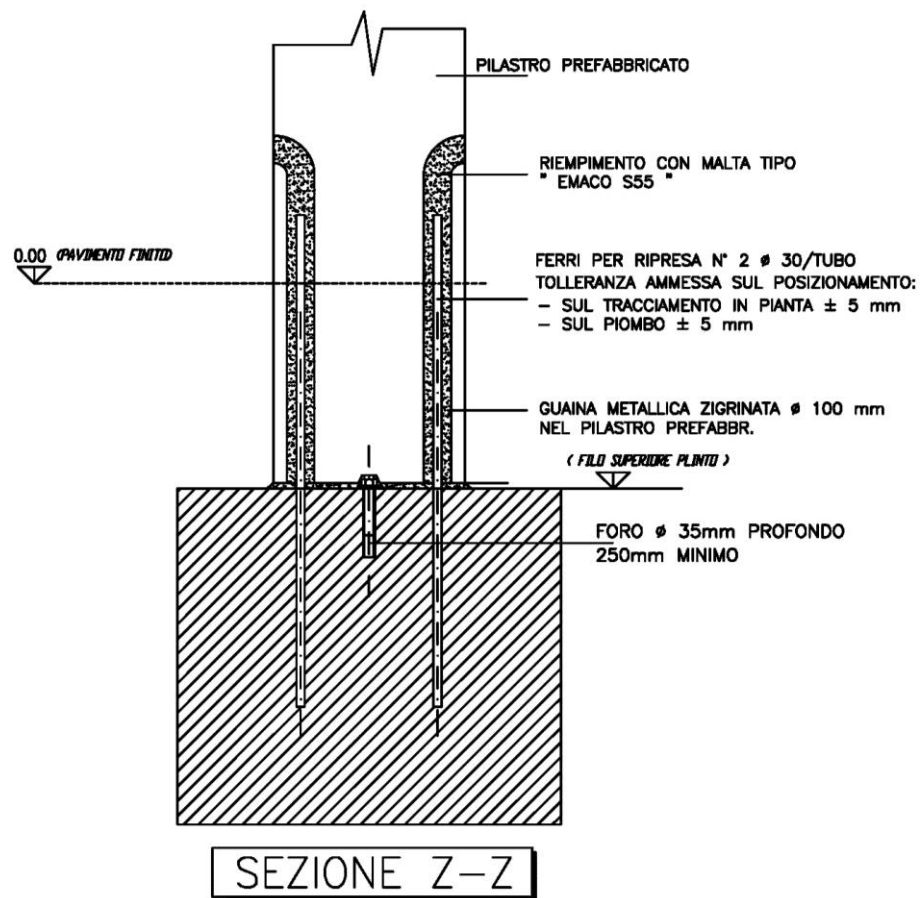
Sezione e particolare costruttivo pilastro prefabbricato
